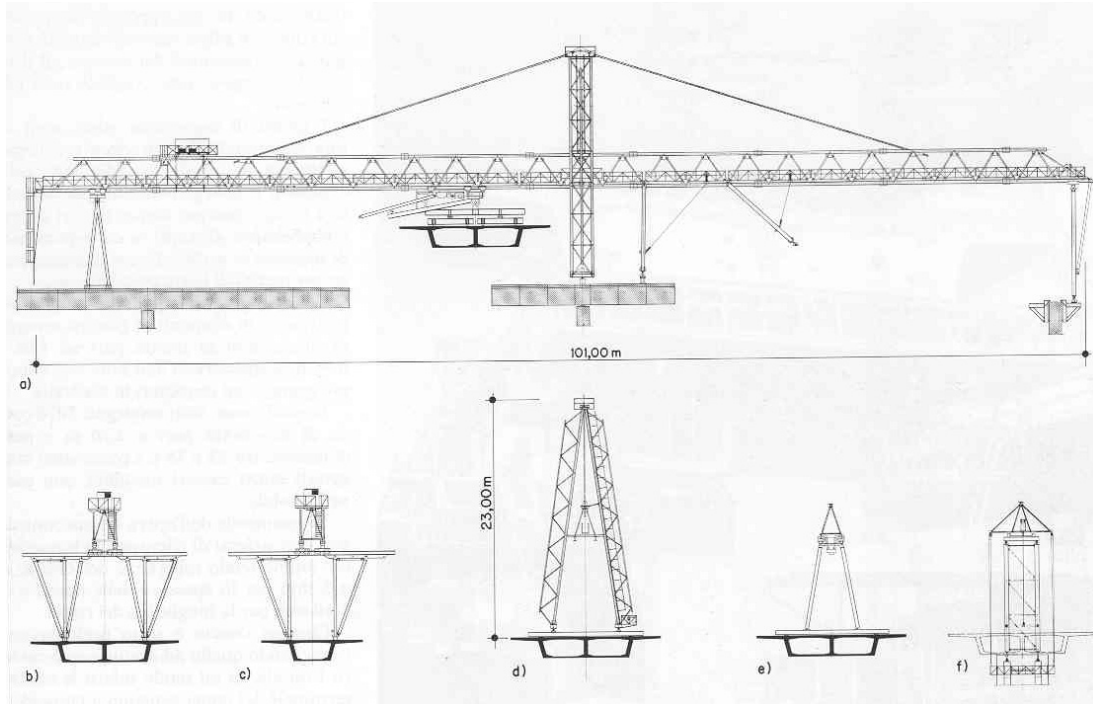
Schema della trave di varo: a) prospetto; b)-c) appoggio posteriore; d) appoggio centrale; e) in fase di avanzamento; f) supporto provvisorio.
